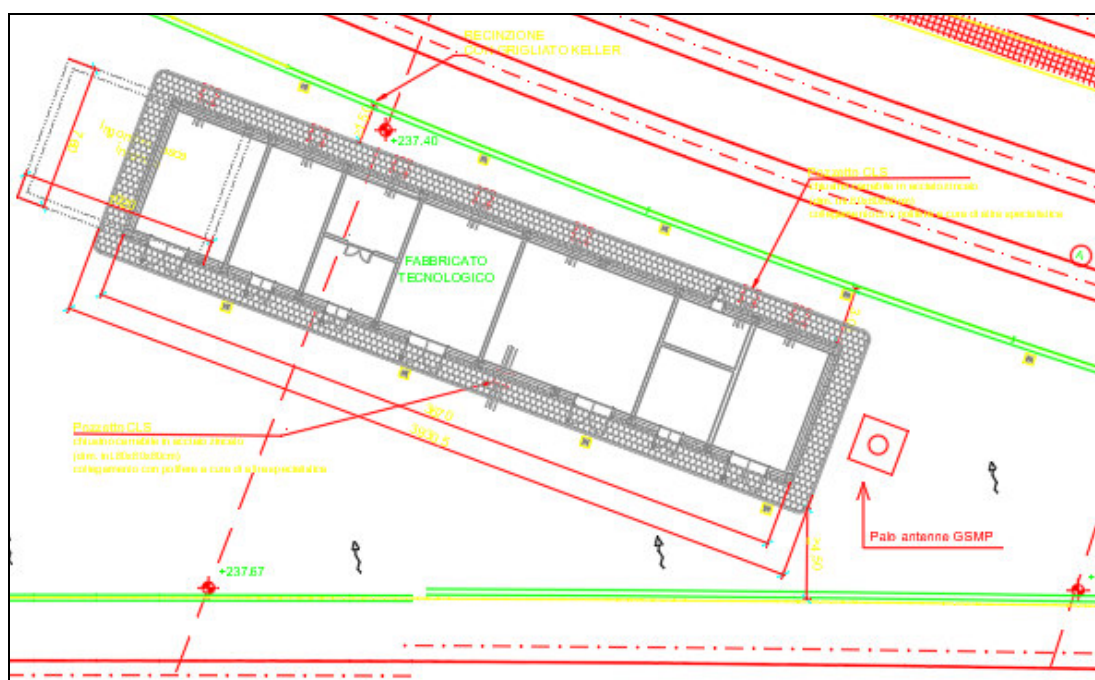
Stralcio planimetria con evidenza inserimento palo
